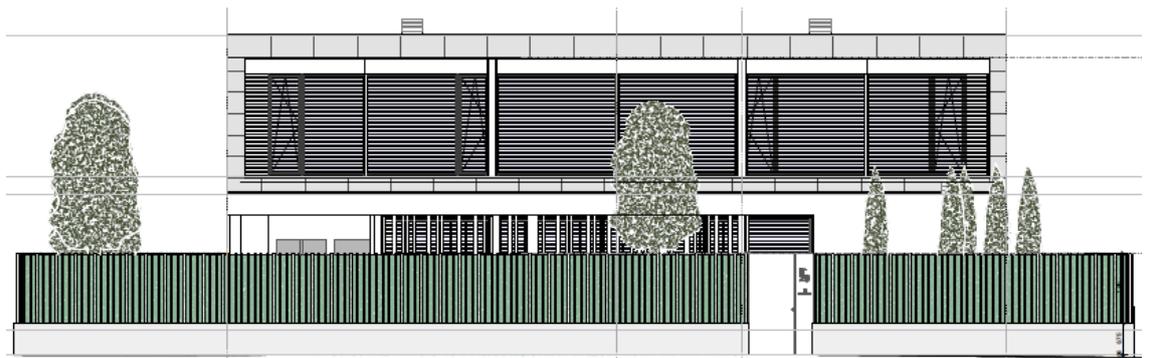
Alzado sur (Principal). 2019. Planos del Proyecto
